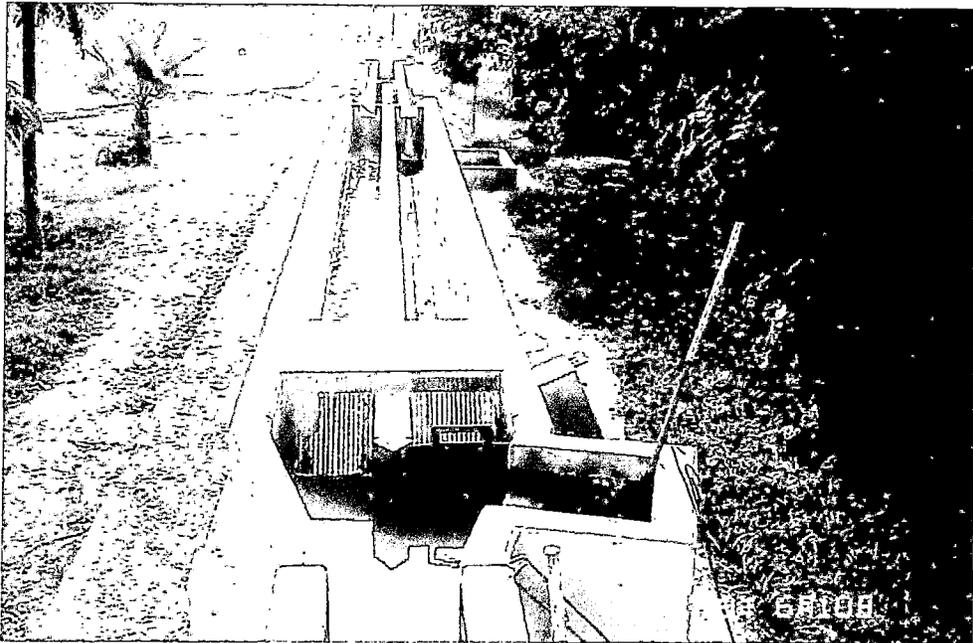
Desarenador, de forma trapezoidal. En esta vista un canal (de la izquierda) está trabajando mientras el otro canal está en mantenimiento.
